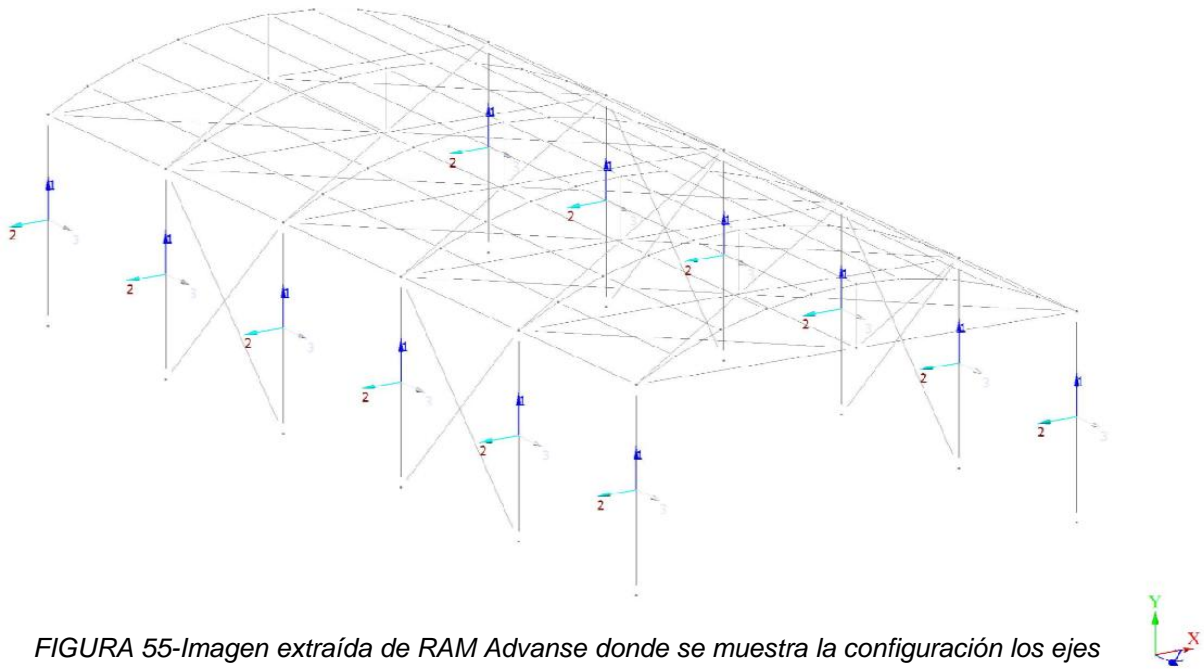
Imagen extraída de RAM Advance donde se muestra la configuración los ejes locales de las columnas.
